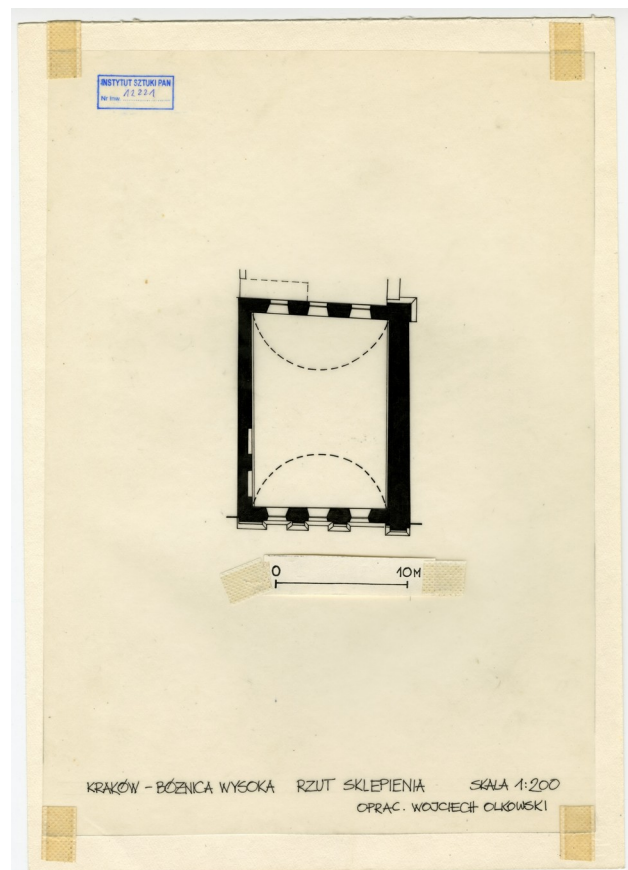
Grundriss OG, Fensterneveau, 1960er Jahre
